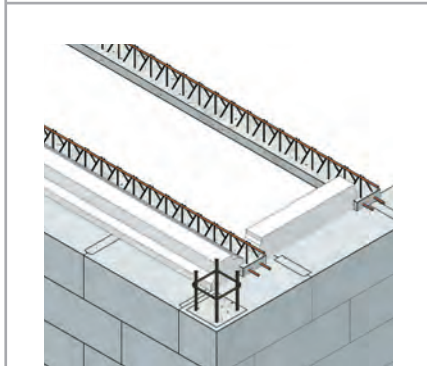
Pose de la deuxième poutrelle et du premier rupteur Pérïbreak d'about
